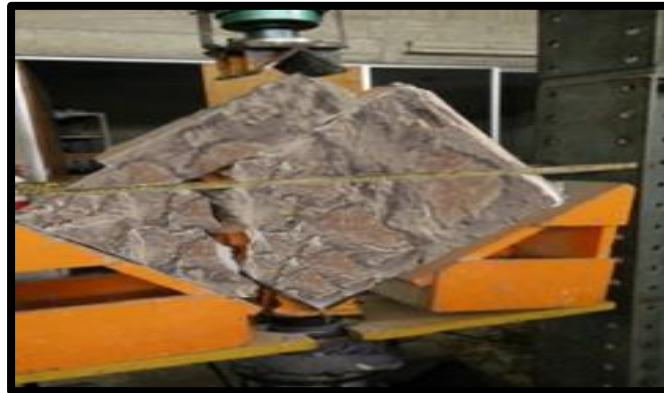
Murete de pirca colocada en la maquina sin reforzamiento
